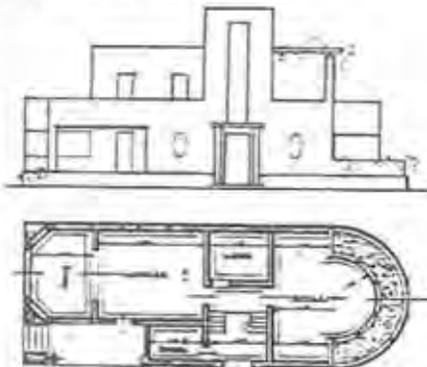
Grundriß und Fassade vom Kiosk, Boulak/Kairo, 1930
